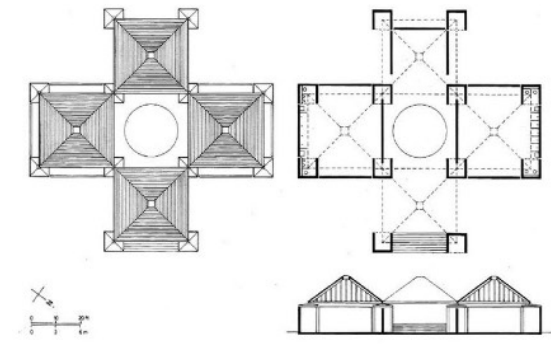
Plantas y alzado de la Casa de Baños, Trenton
